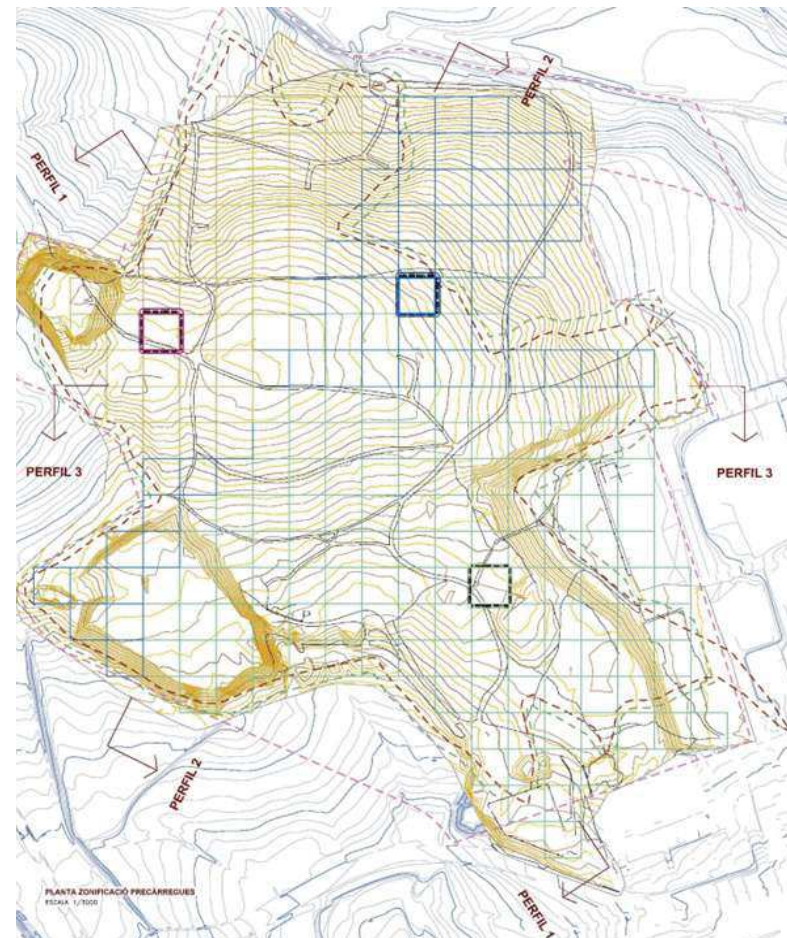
Planta de zonificació de les zones de precàrrega en base als perfils extrets
